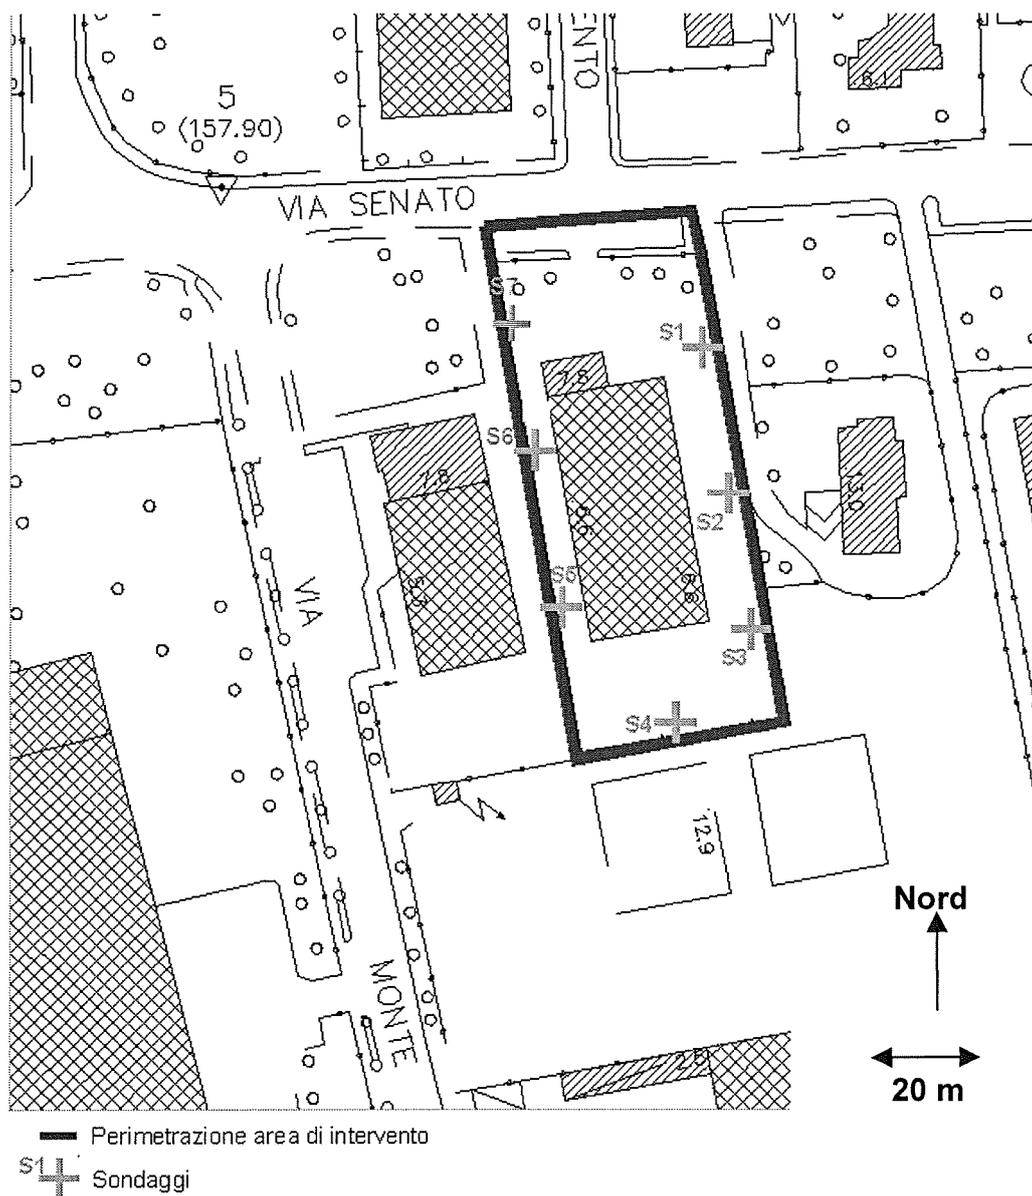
planimetria di progetto con ubicazione dei punti di indagine (estratto degli elaborati di progetto, stato di fatto - scala grafica).
